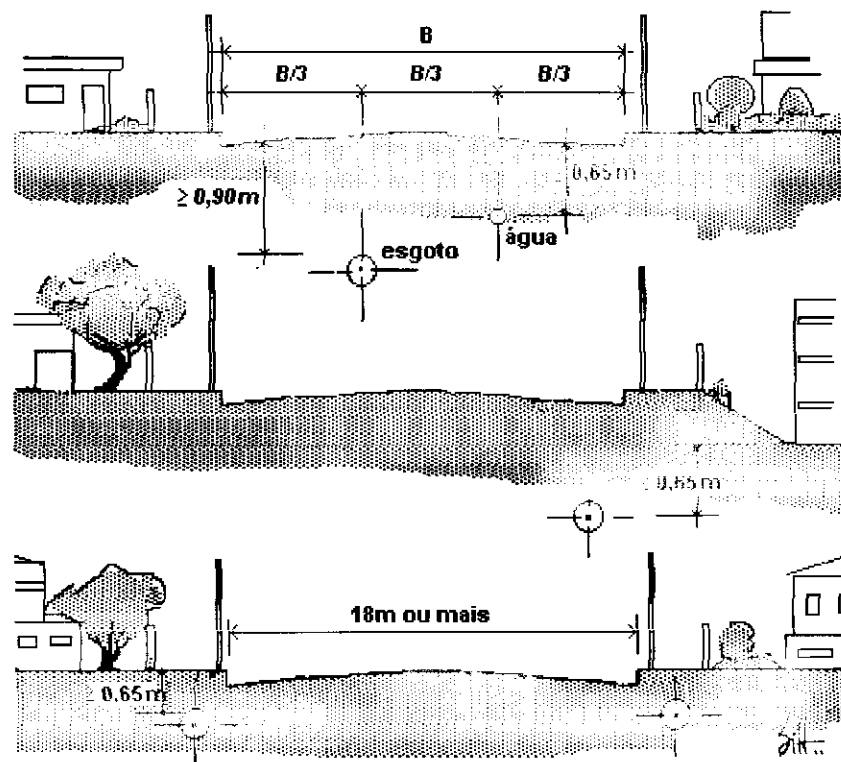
4 - Exemplos de perfis transversais de arruamentos e posicionamento dos coletores
